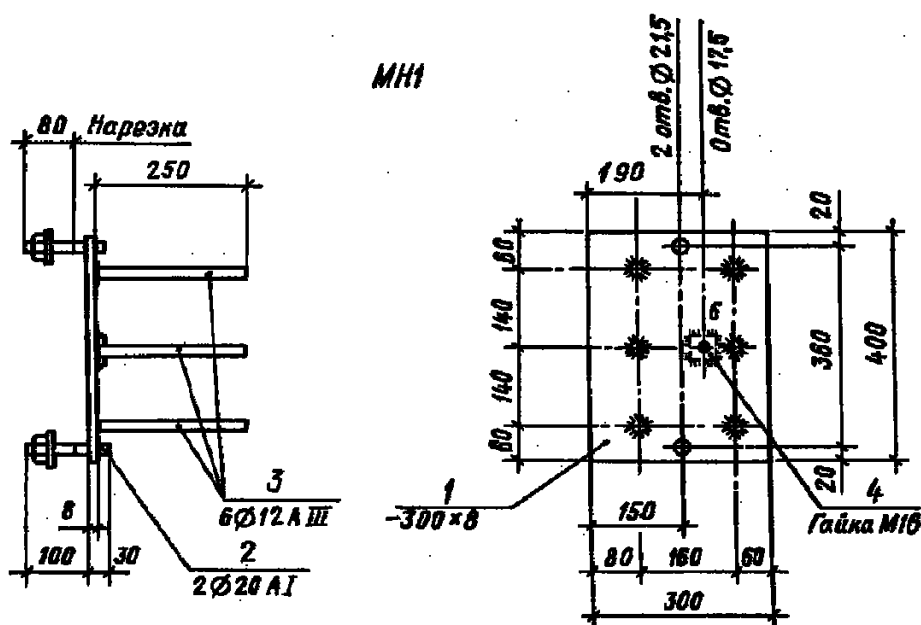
Сборочный чертёж закладной соединительной детали
